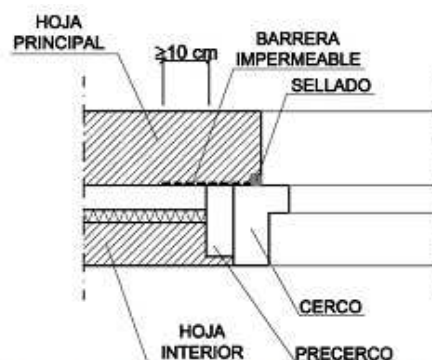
Ejemplo de encontro de la fachada con la carpintería
